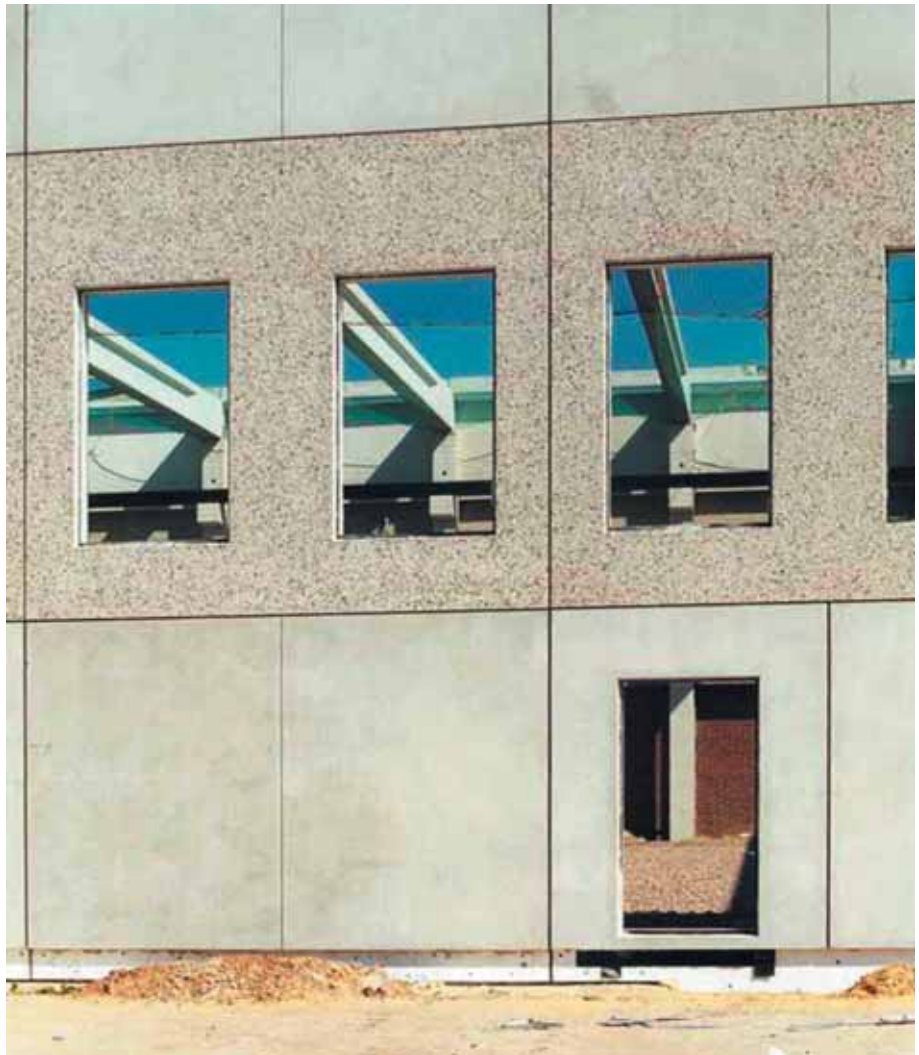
Opname van gevel met daarachter de I-balken, de primaire liggers, opgelegd op kolommen
